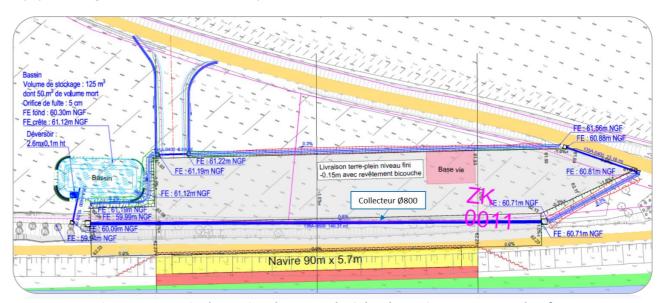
Bassin de gestion des eaux pluviales du quai travaux et sa plateforme
